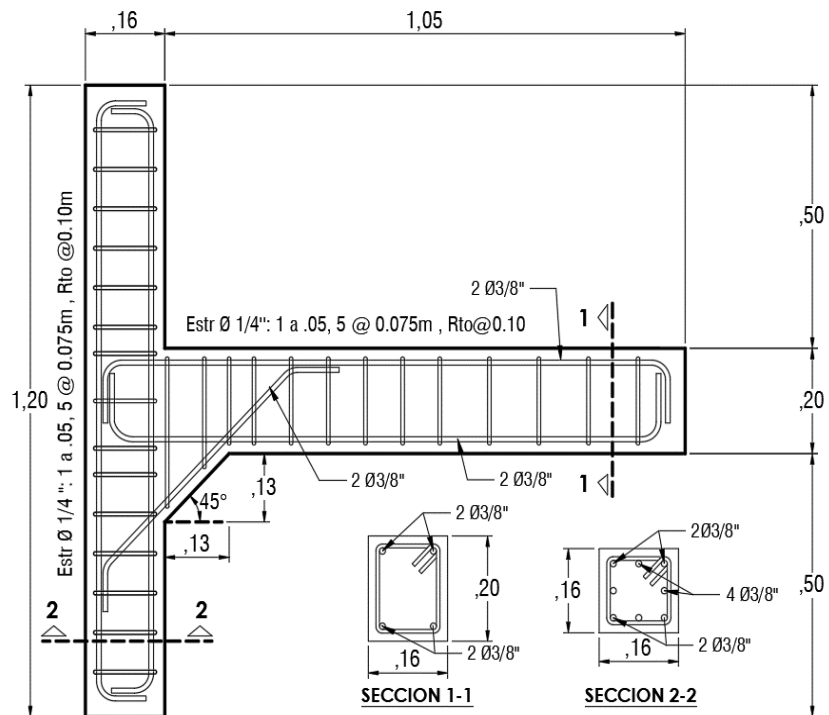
PLANO DEL MODELO ESPÉCIMEN REFORZADO CON CARTELA
